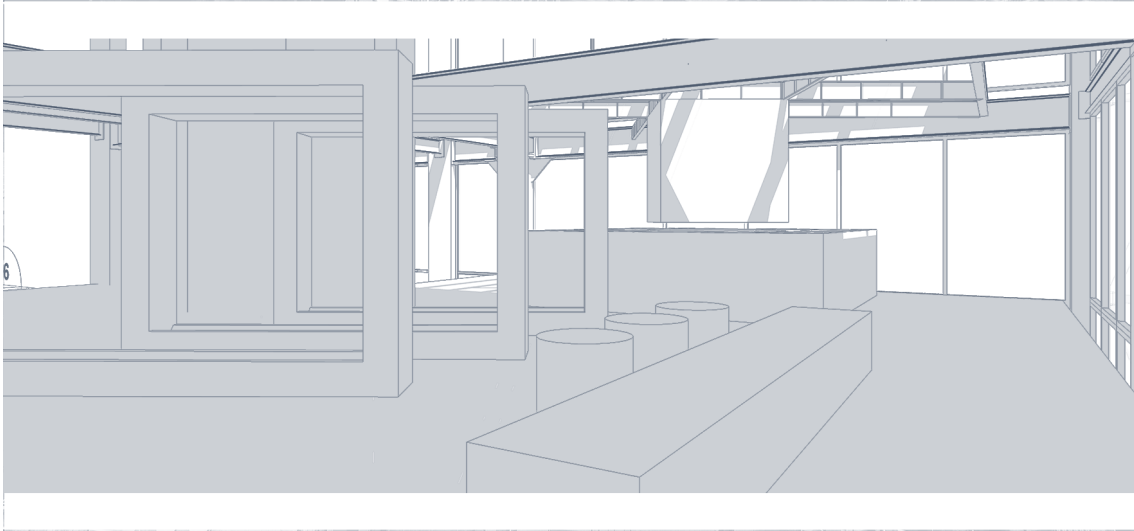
Lavandería manual y tanque de reserva. Elaboración propia.
